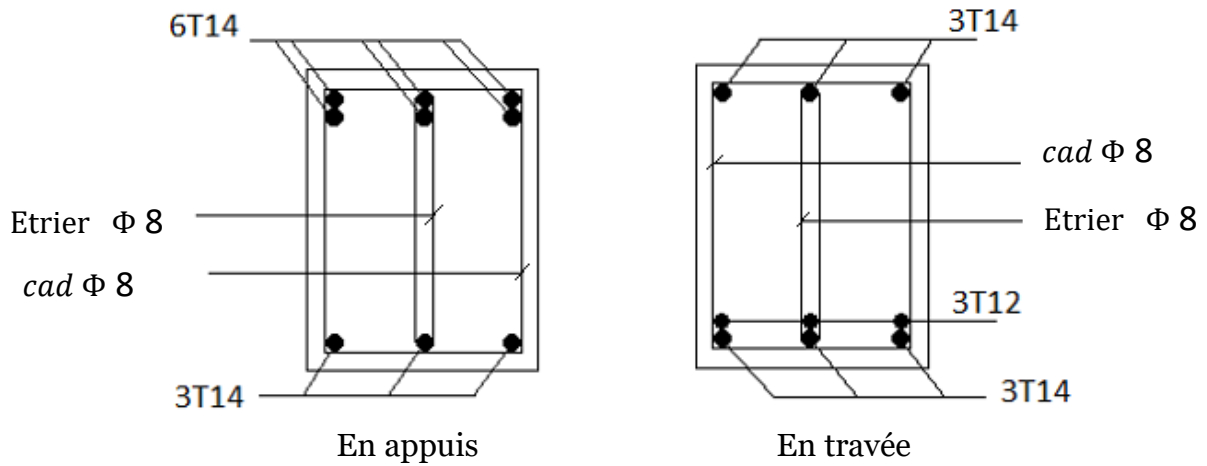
schéma de ferrailage de la poutre principale (30 × 45)cm²
